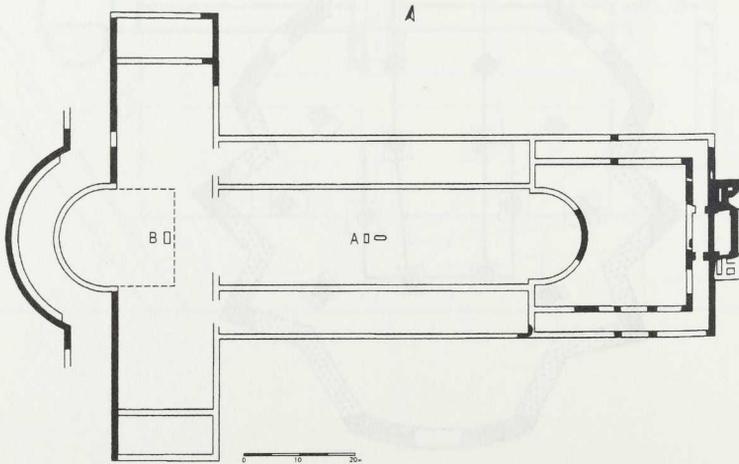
Fulda, Abteikirche, Ratgarbau, Grundriß (nach Jacobsen)
